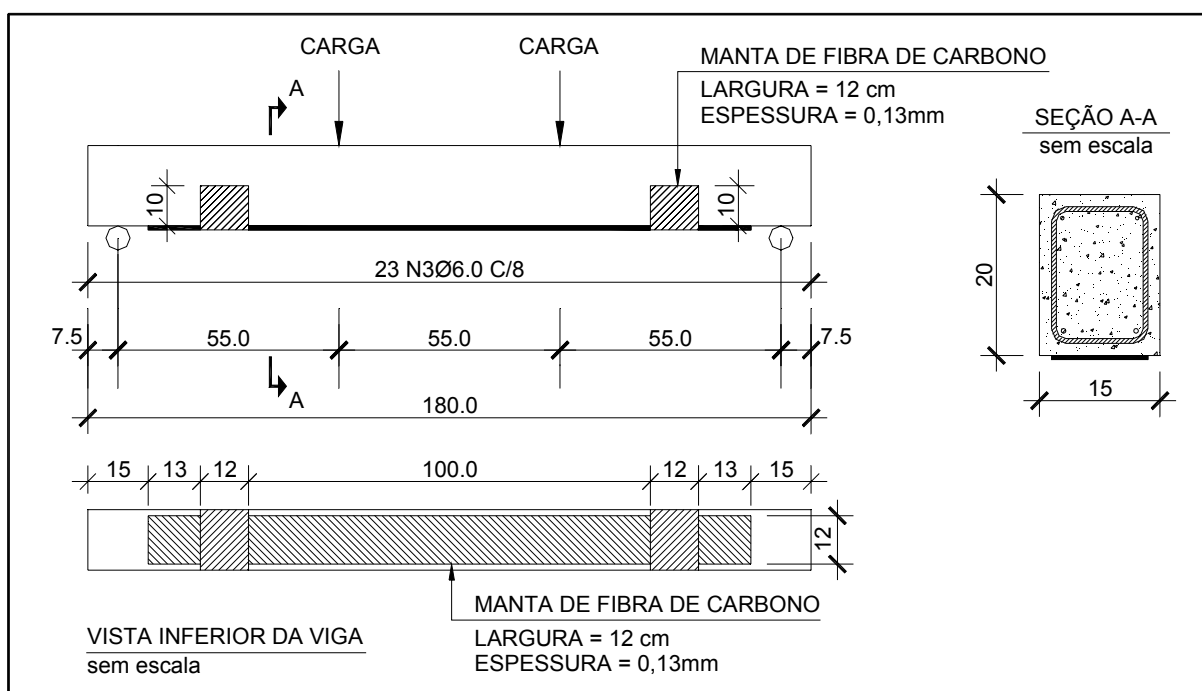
Disposição do reforço das vigas VR7 e VR8
